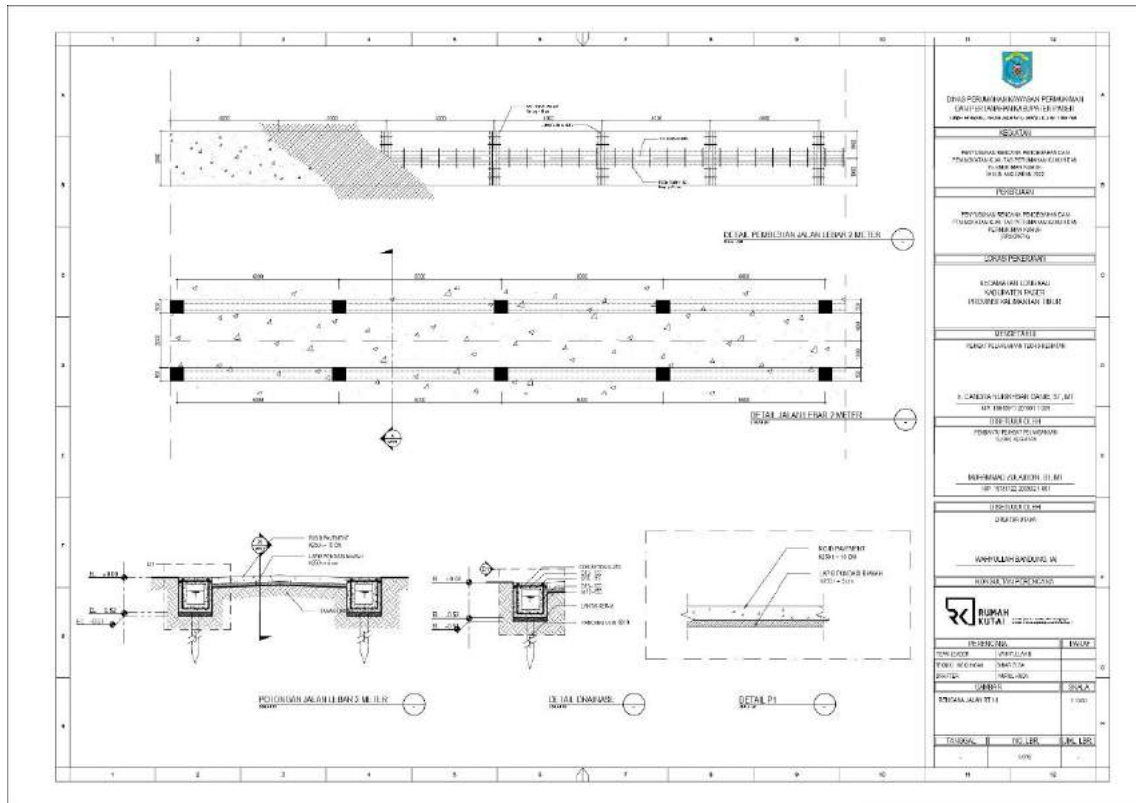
95 Konsep Recana Jalan Segmen 13 RT.14
